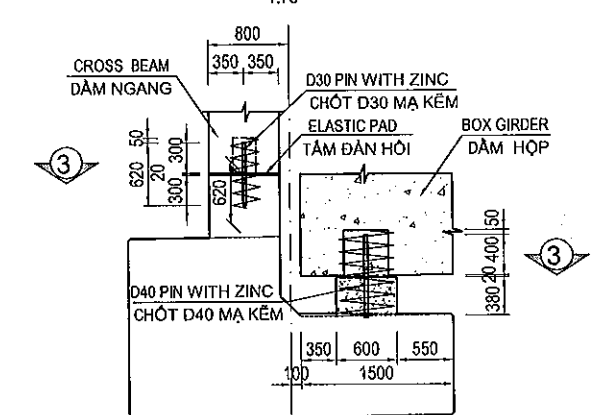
DETAIL PIER CAP - CHI TIẾT XÀ MŨ TRỤ
